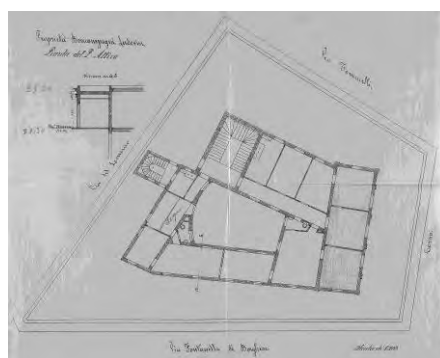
palazzo Boncompagni Ludovisi Pianta piano attico progetto
